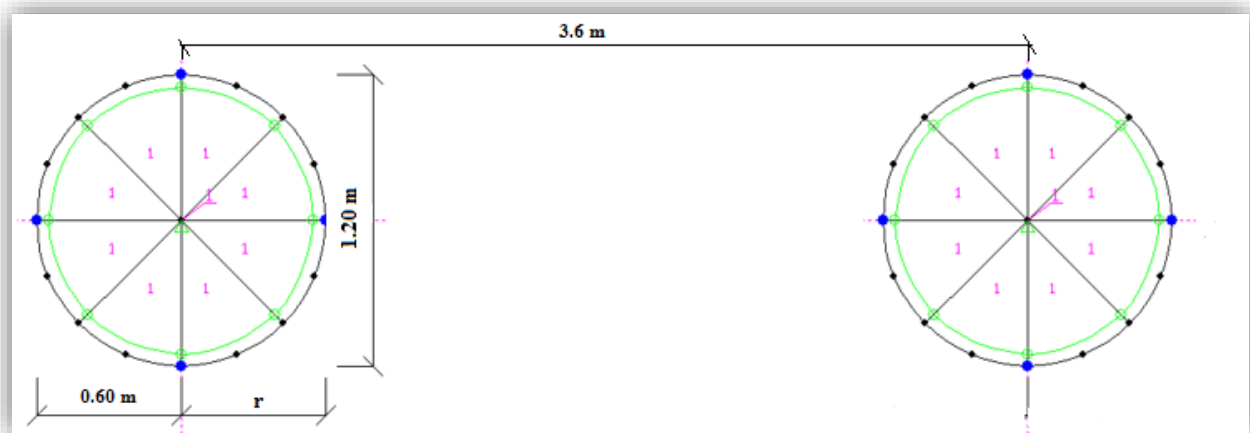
Section transversale de la pile modélisée par RM bridge.
